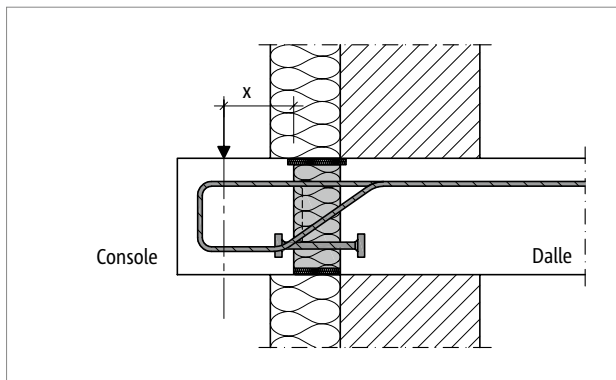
Schöck Isokorb® T type O : corniche périphérique
